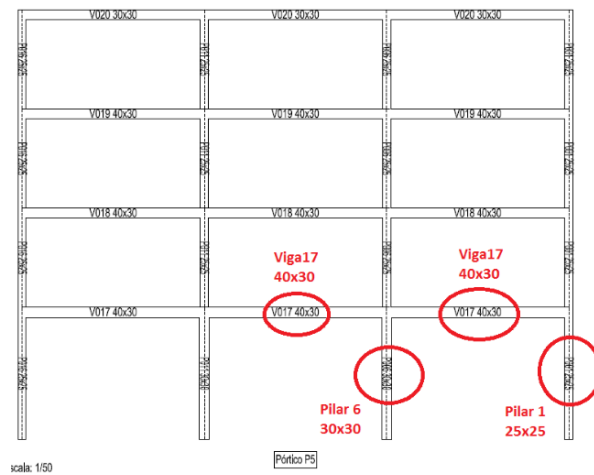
Vigas que acometen en cabeza de pilar 6 y 1. Pórtico incluido en el plano 3 del Anexo I
